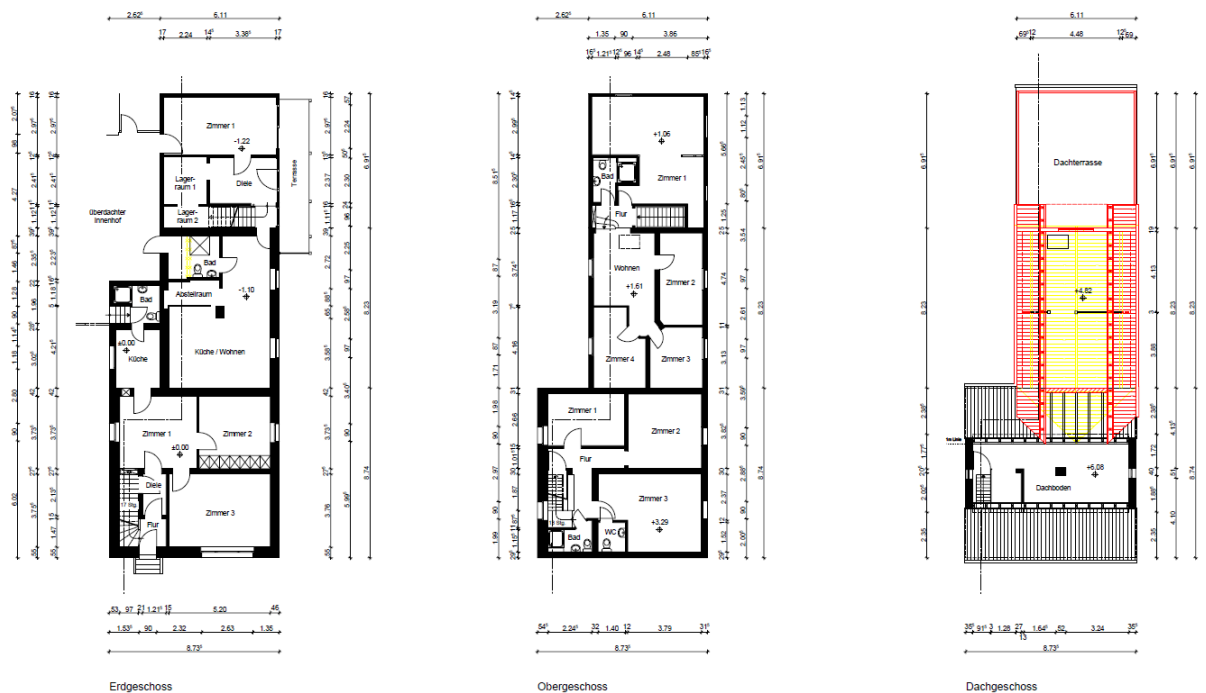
Grundrisse des Bauvorhabens (Quelle: Architekturbüro Bergermann)
